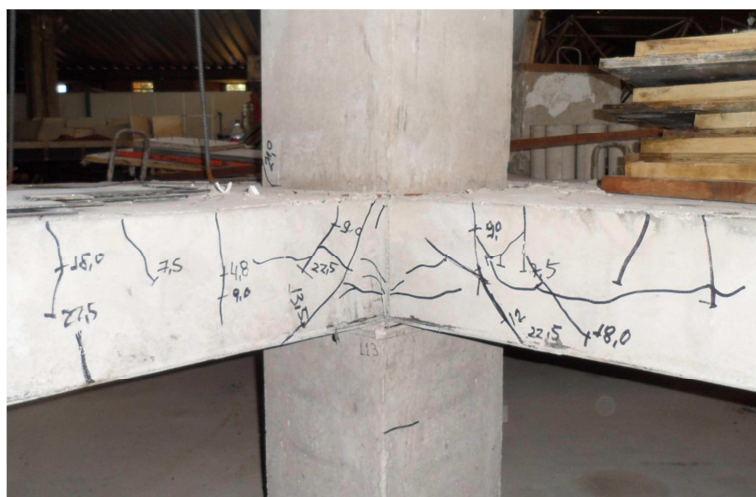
Aspecto das fissuras na reentrância da laje LR04
